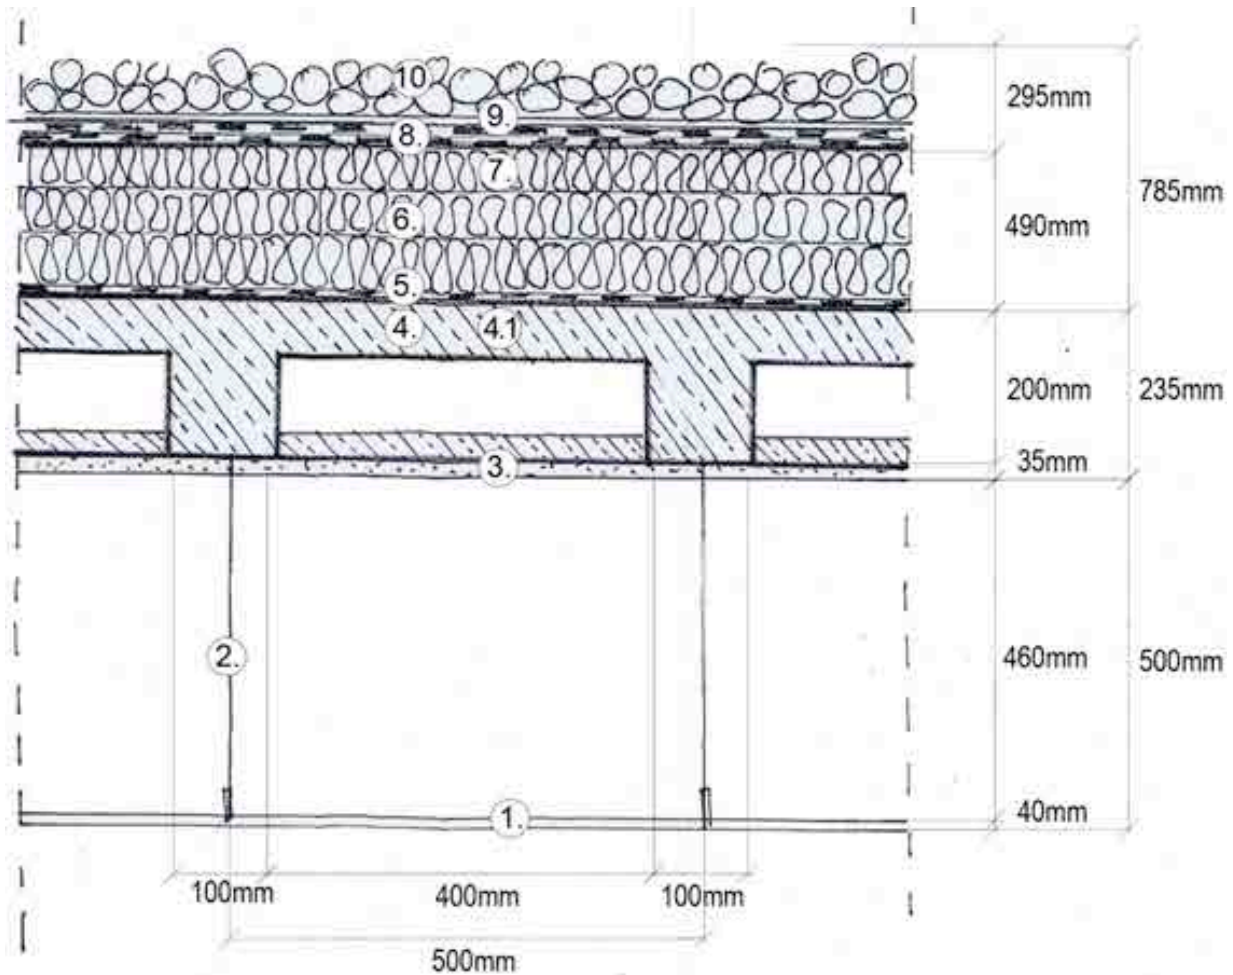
Bauteil, Dachbeläge, Decke Bestand\_20cm\_6cm
